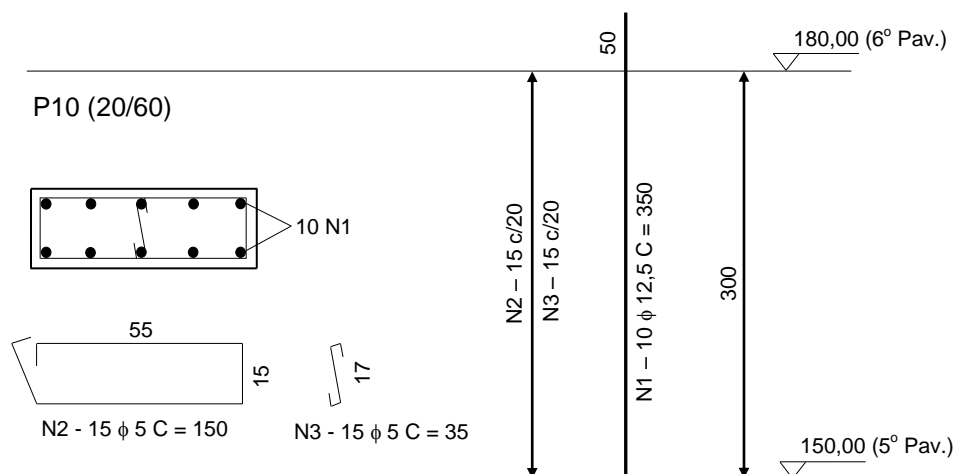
Detalhamento típico de armadura de pilar em um pavimento.
